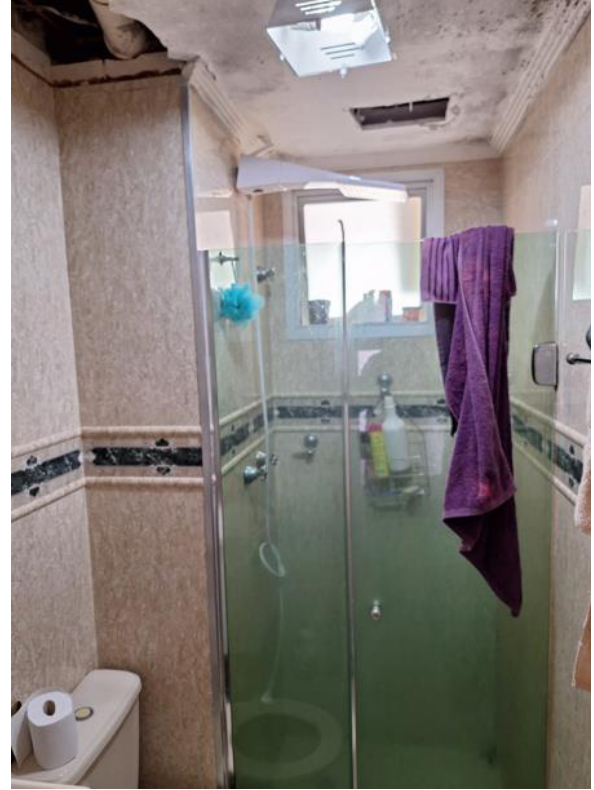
e 23 – Banheiro social (Forro deteriorado)
